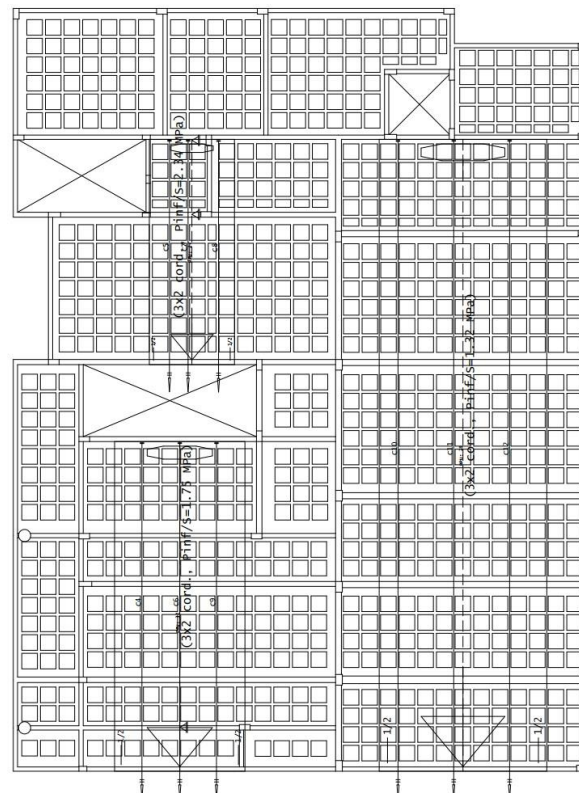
Traçado de RPU verticais e distribuição de cabos do sistema de laje nervurada bidirecional protendida no TQS. (Fonte: Autoria própria; 2023)
